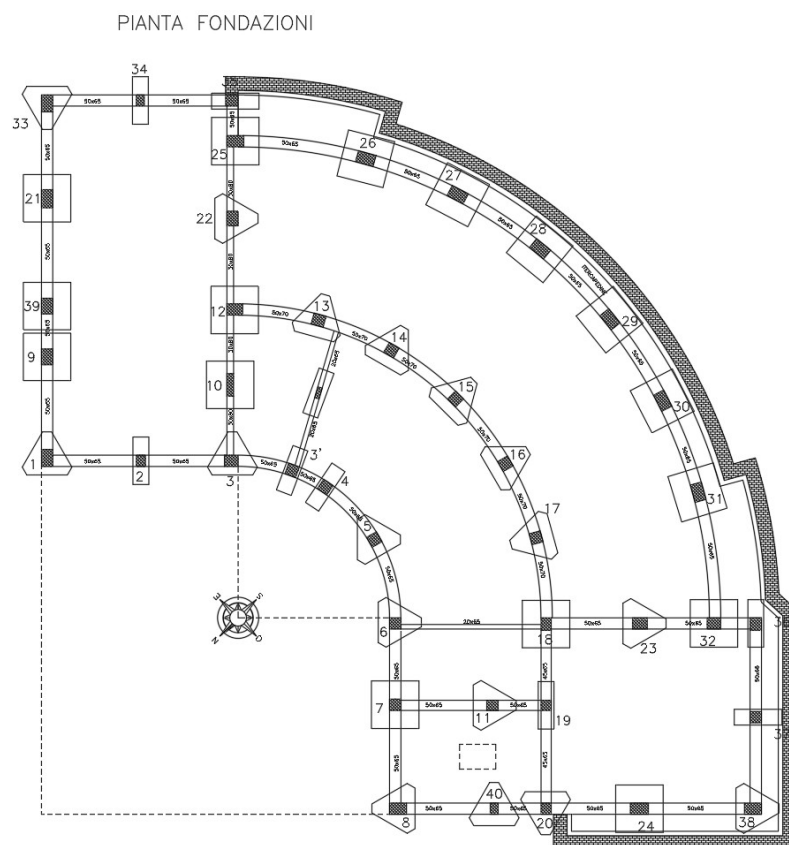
Pianta fondazioni e cunicolo perimetrale.
